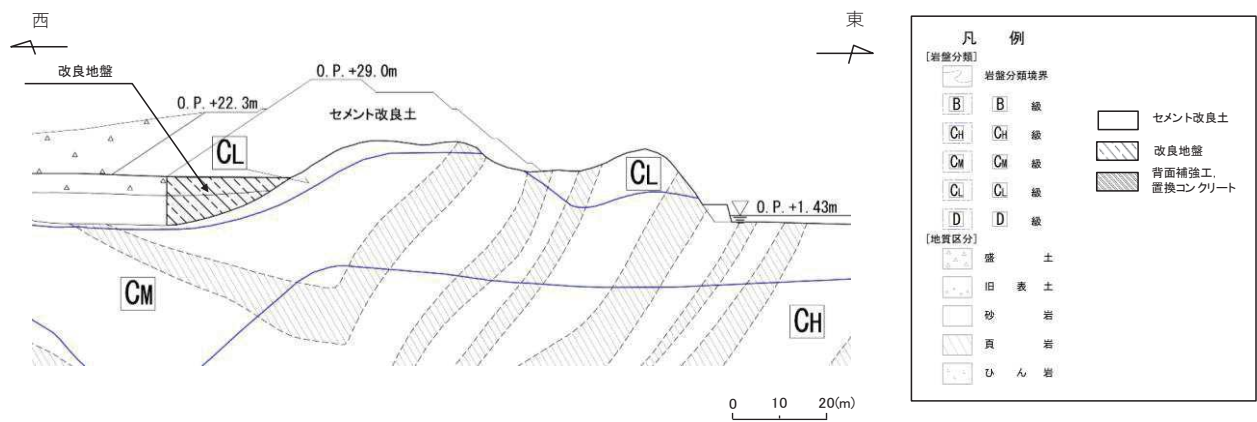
盛土堤防断面図 (I' 区間)
